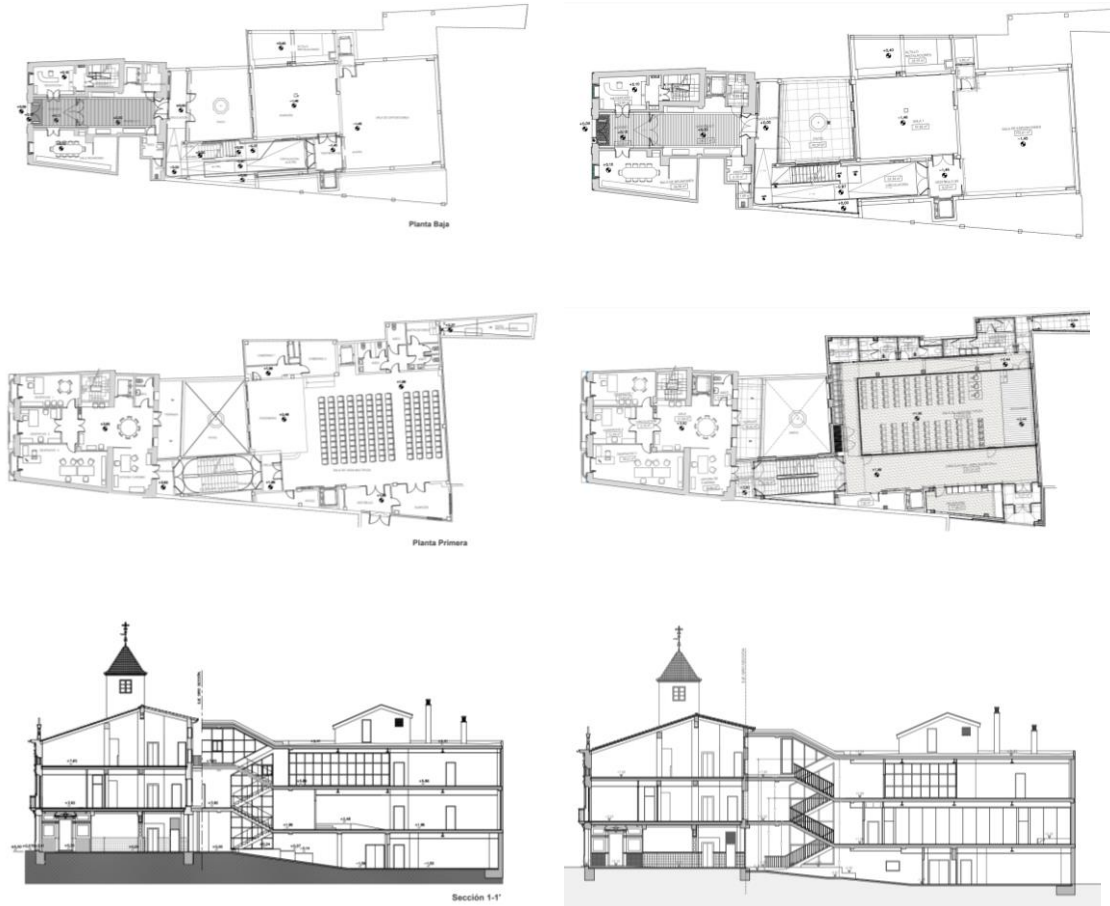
Estado actual y estado tras la intervención. Fuente: Planos del proyecto.
